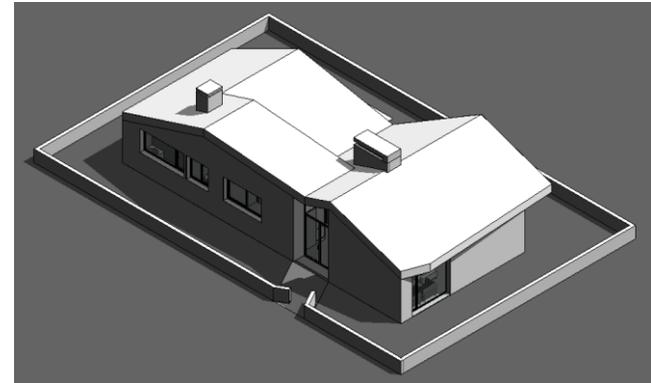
Unión muro y cubierta por defecto. Fuente propia.
